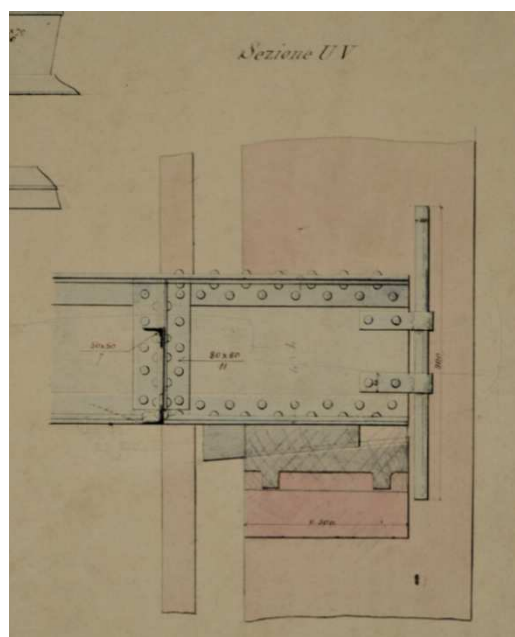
Dettaglio delle travature in acciaio dei bracci longitudinali (nodo tra il muro portante e la trave principale)
